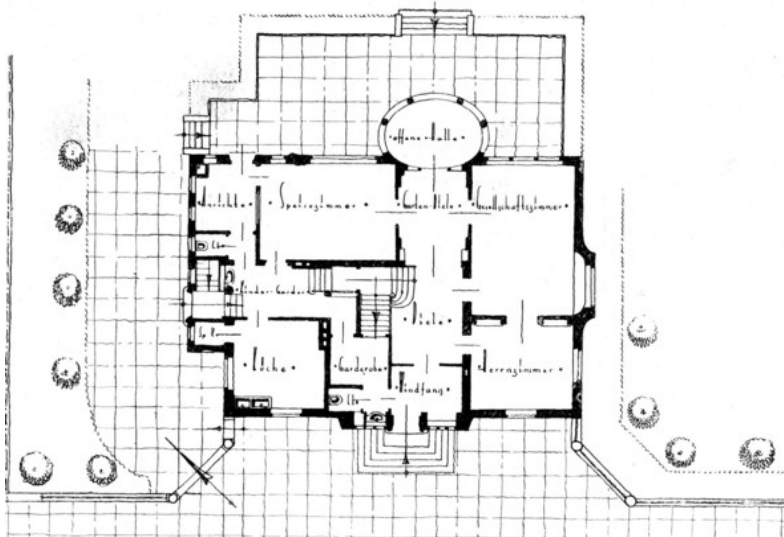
Grundriss des Wohnhauses für Direktor V. Funk, Düsseldorf/ Meliesallee 1 – Architekt: Walter Furthmann
